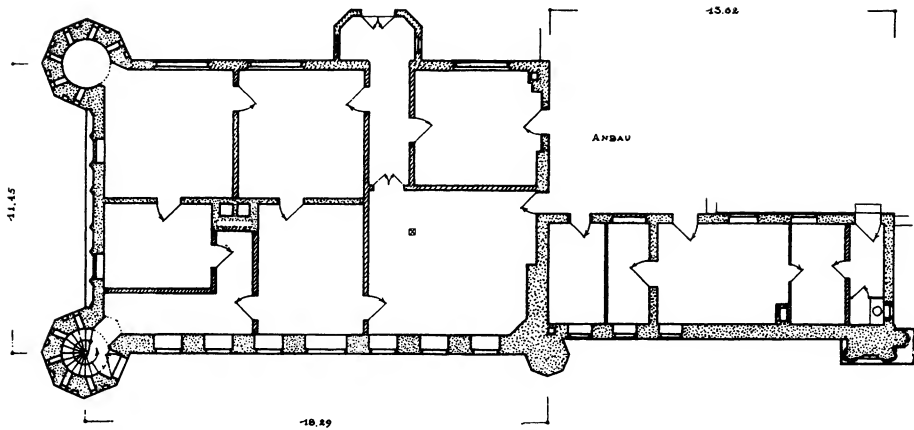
Heideburg. Grundriß (Maßstab 1:300)
